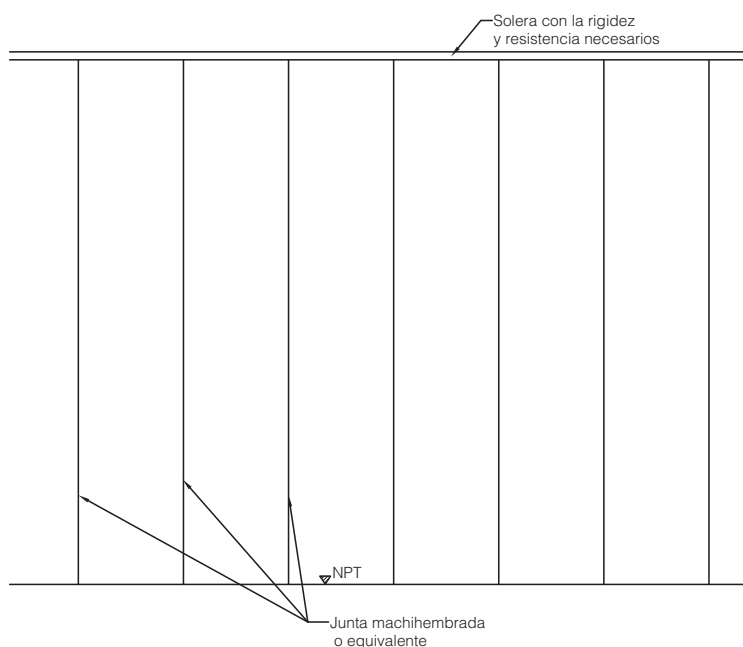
Paredes prefabricadas tipo baldosas verticales.
